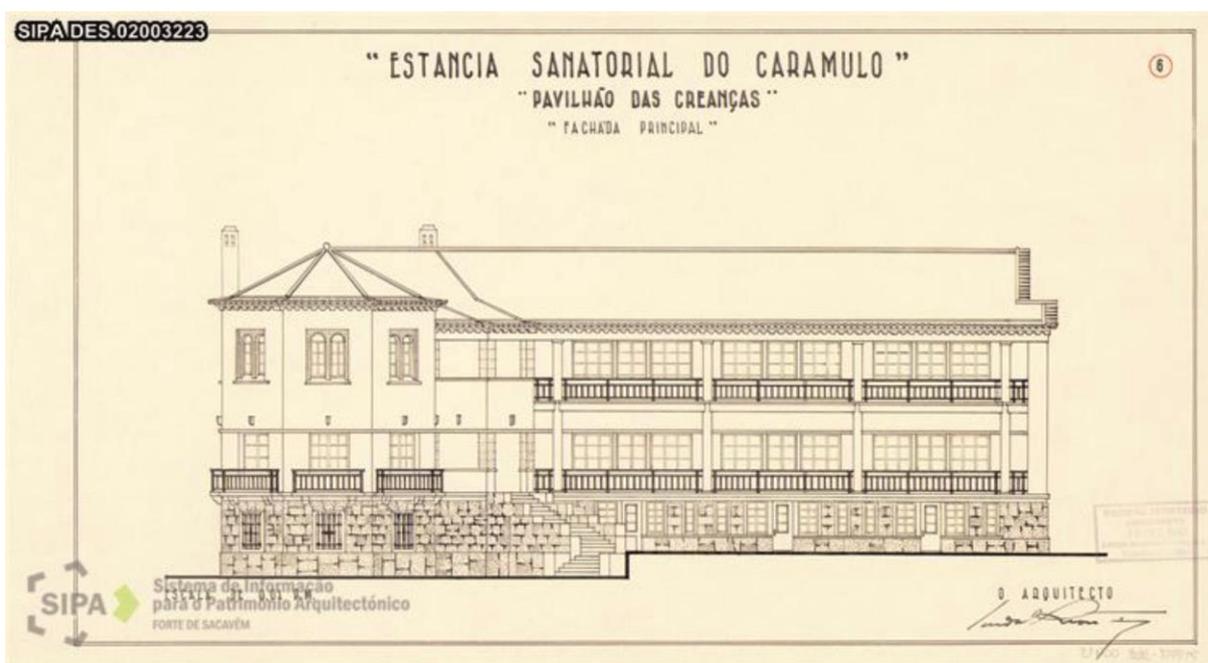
Fachada Principal – projeto de Pardal Monteiro
